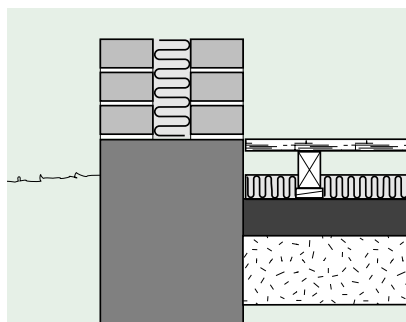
Terrændæk med gulvbrædder, gulvstrøer på kiler, isolering, fugtspærre, betonlag samt singels.
